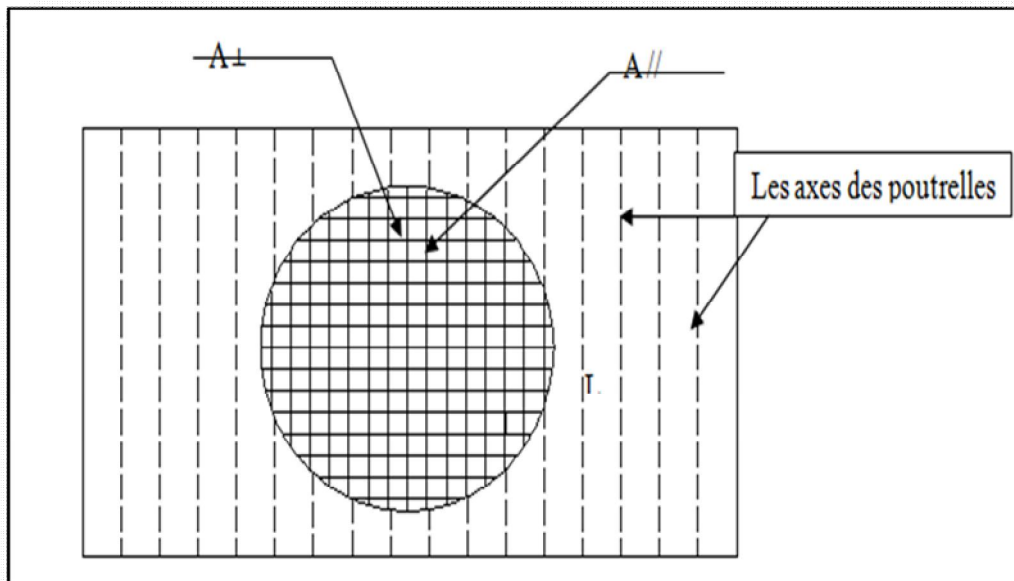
Schéma de Ferrailage de la dalle de compression.
